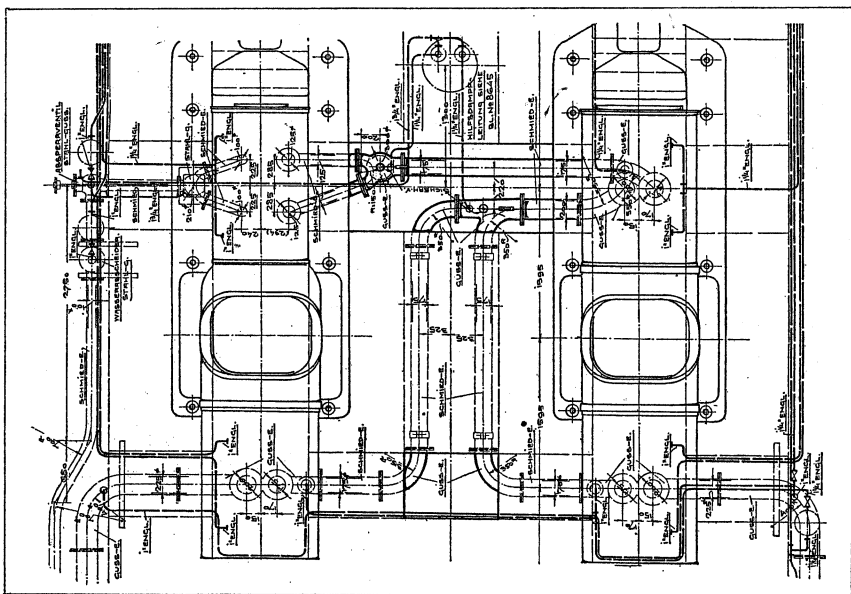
/5: Grundriss mit Maschinen und detailliertem Rohrleitungsplan (um 1890)
